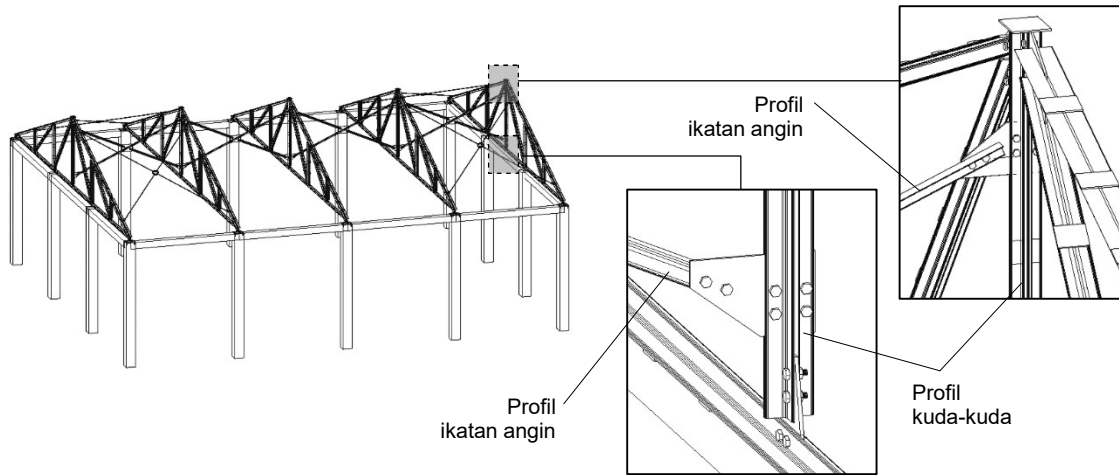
Detail Ikatan Angin & Denah Alternatif Sambungan Tengah
